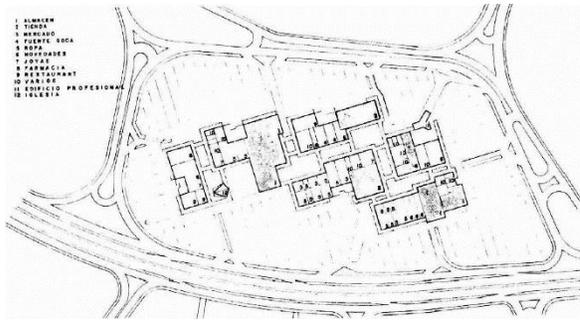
Planta de conjunto del centro comercial de Ciudad Satélite. Fuente: Revista Arquitectura México, No. 60.
